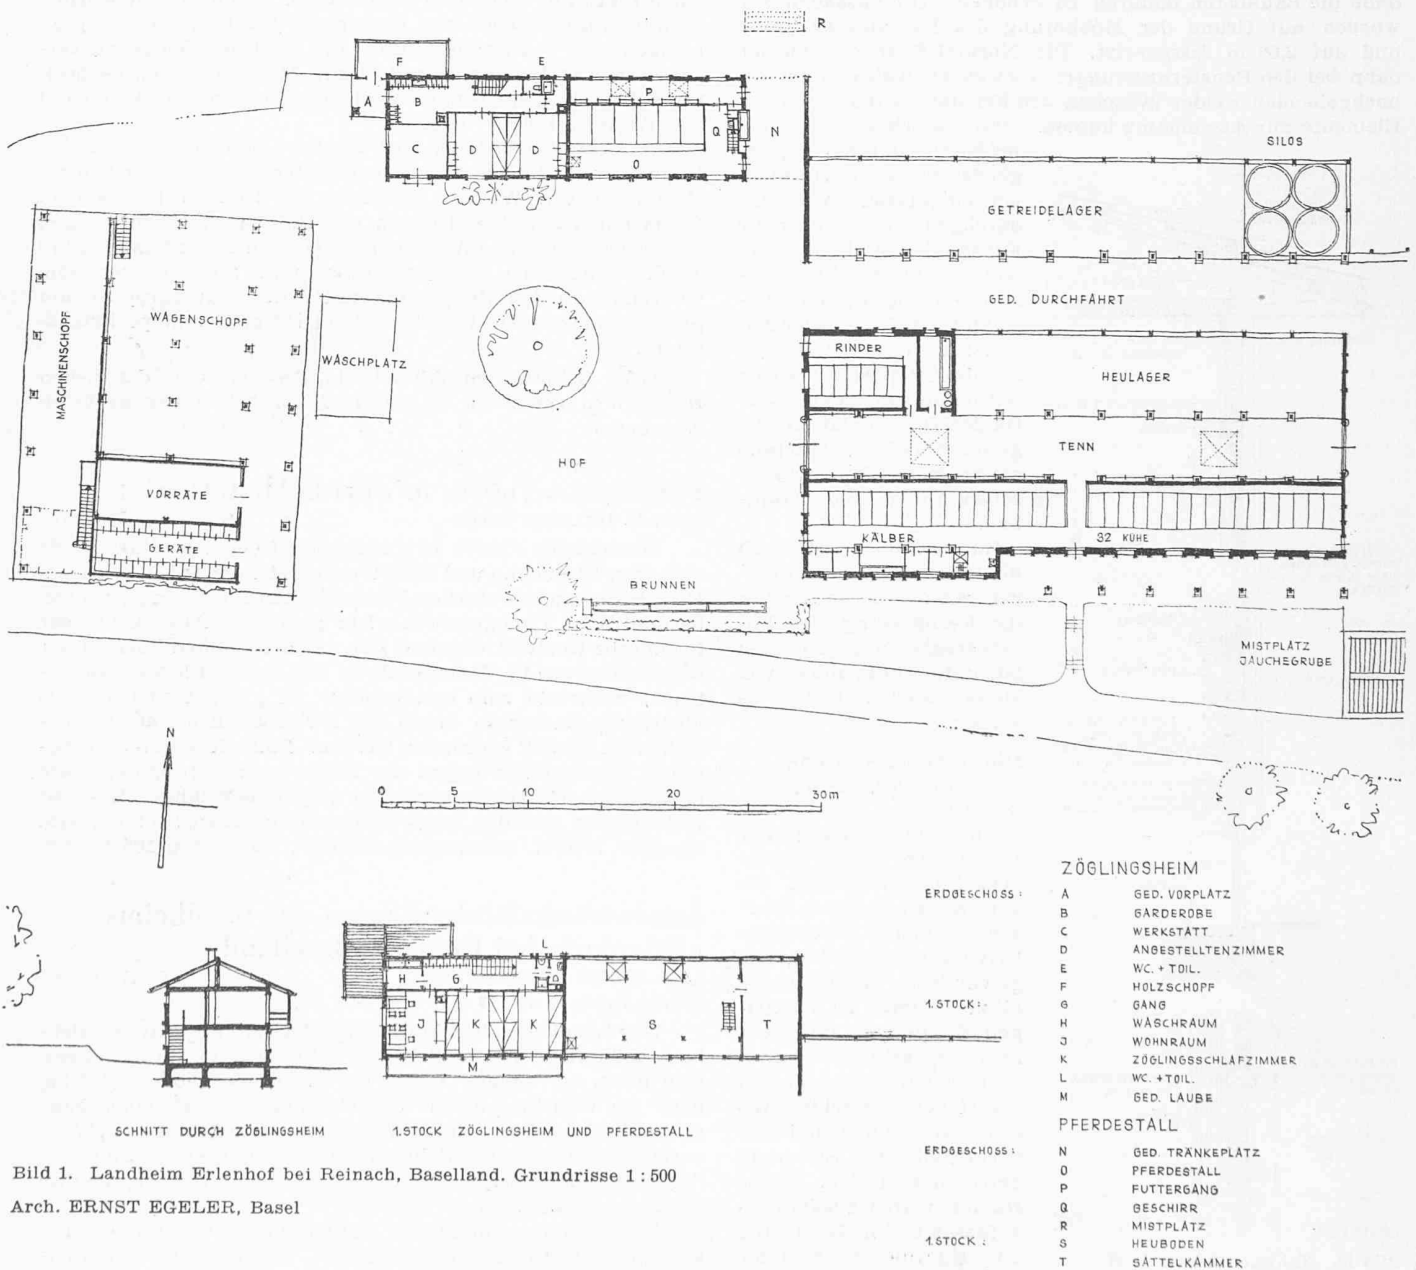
Landheim Erlenhof bei Reinach, Baselland. Grundrisse 1:500
